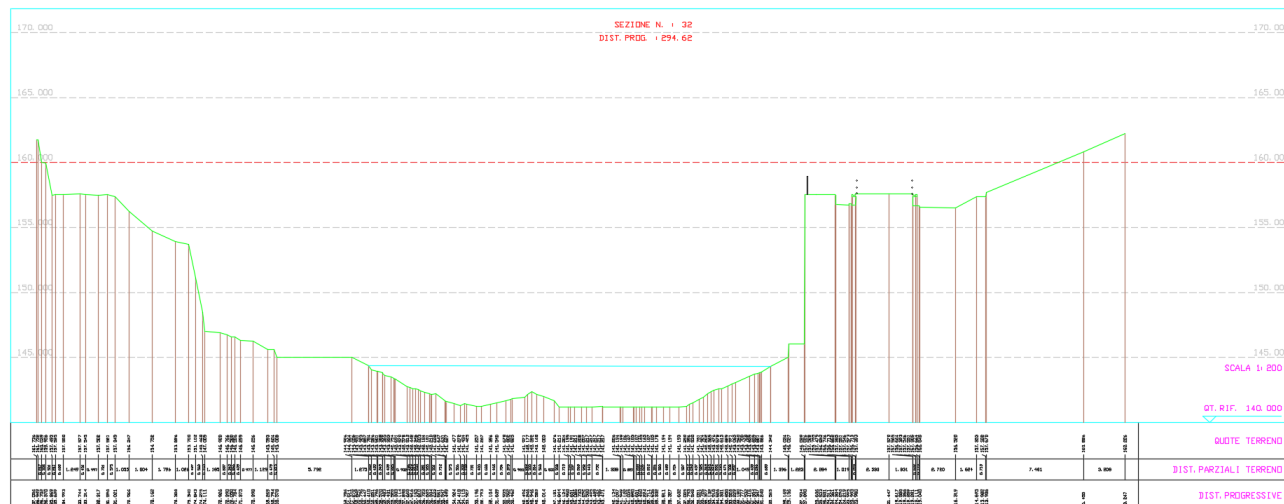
Sezione n.32 trasversale, ricavata dal rilievo batimetrico.
